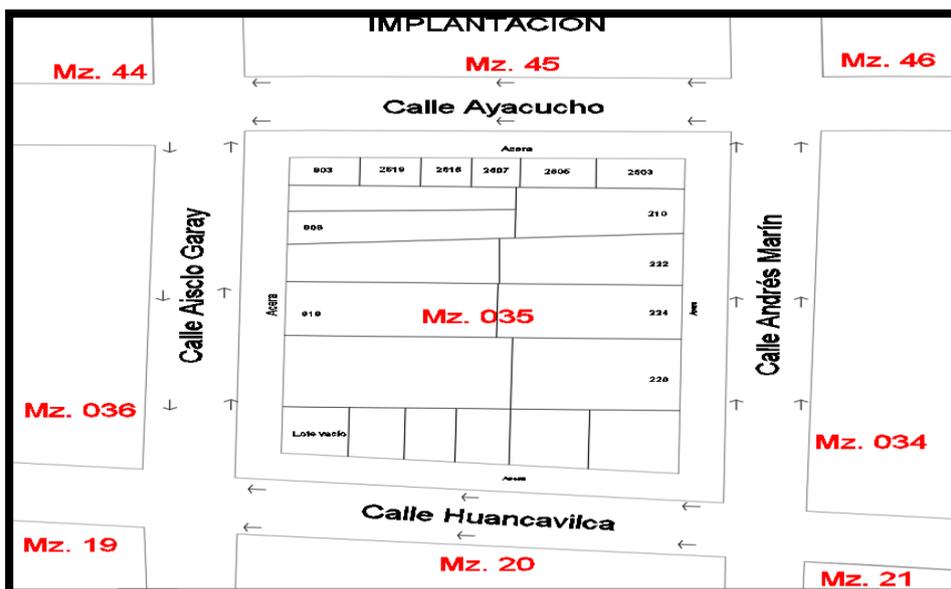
Implantación actual de manzana elegida en Barrio Garay
